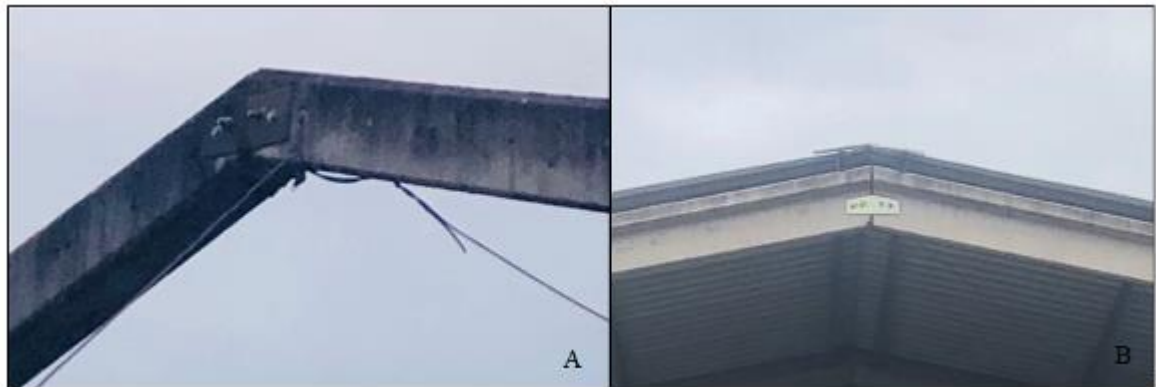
Estruturas de concreto ligadas por apoio das peças
